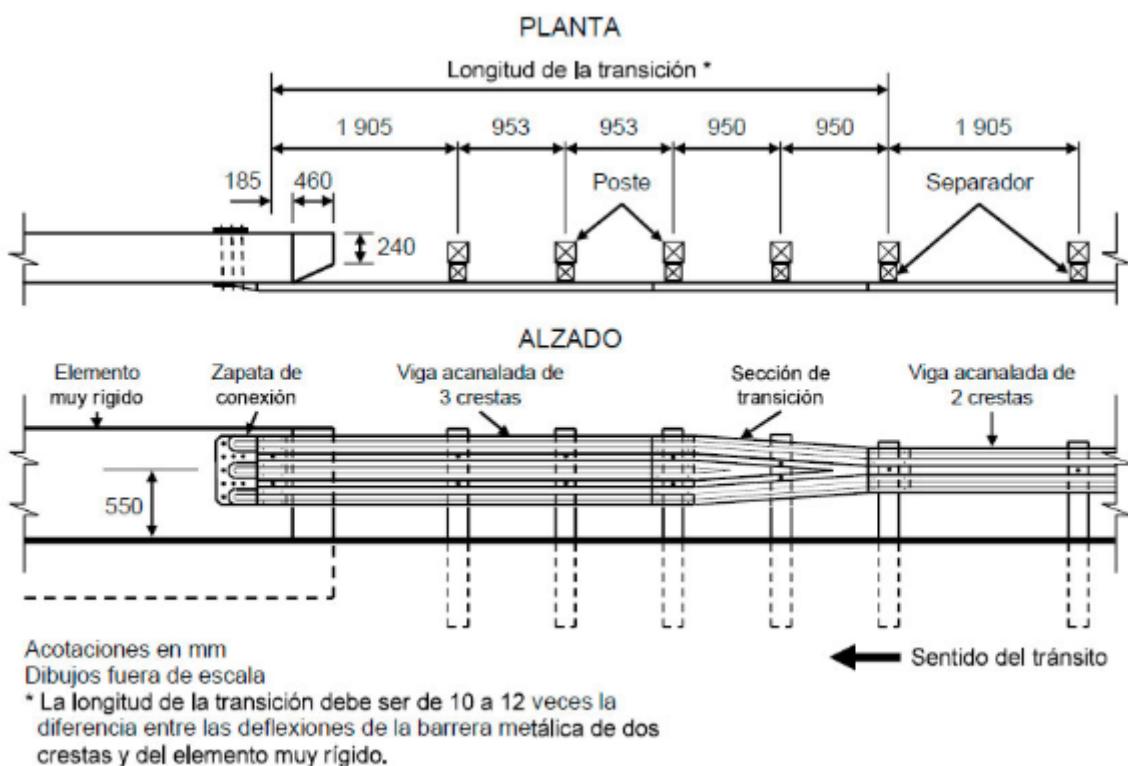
Anclaje de barrera flexible en barrera rígida de puente. (Fuente: ManufacturasCarmen).
